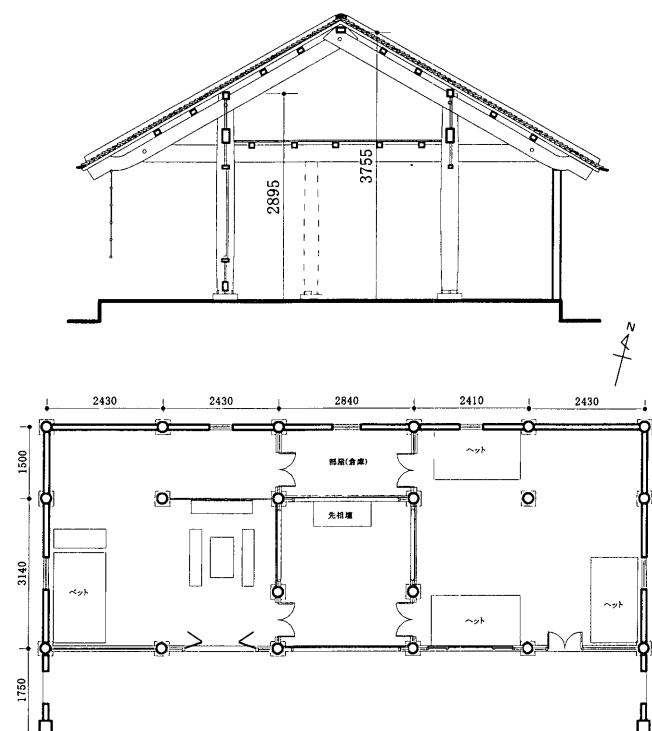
Nguyễn Hữu Chinh 宅／断面図・平面図
